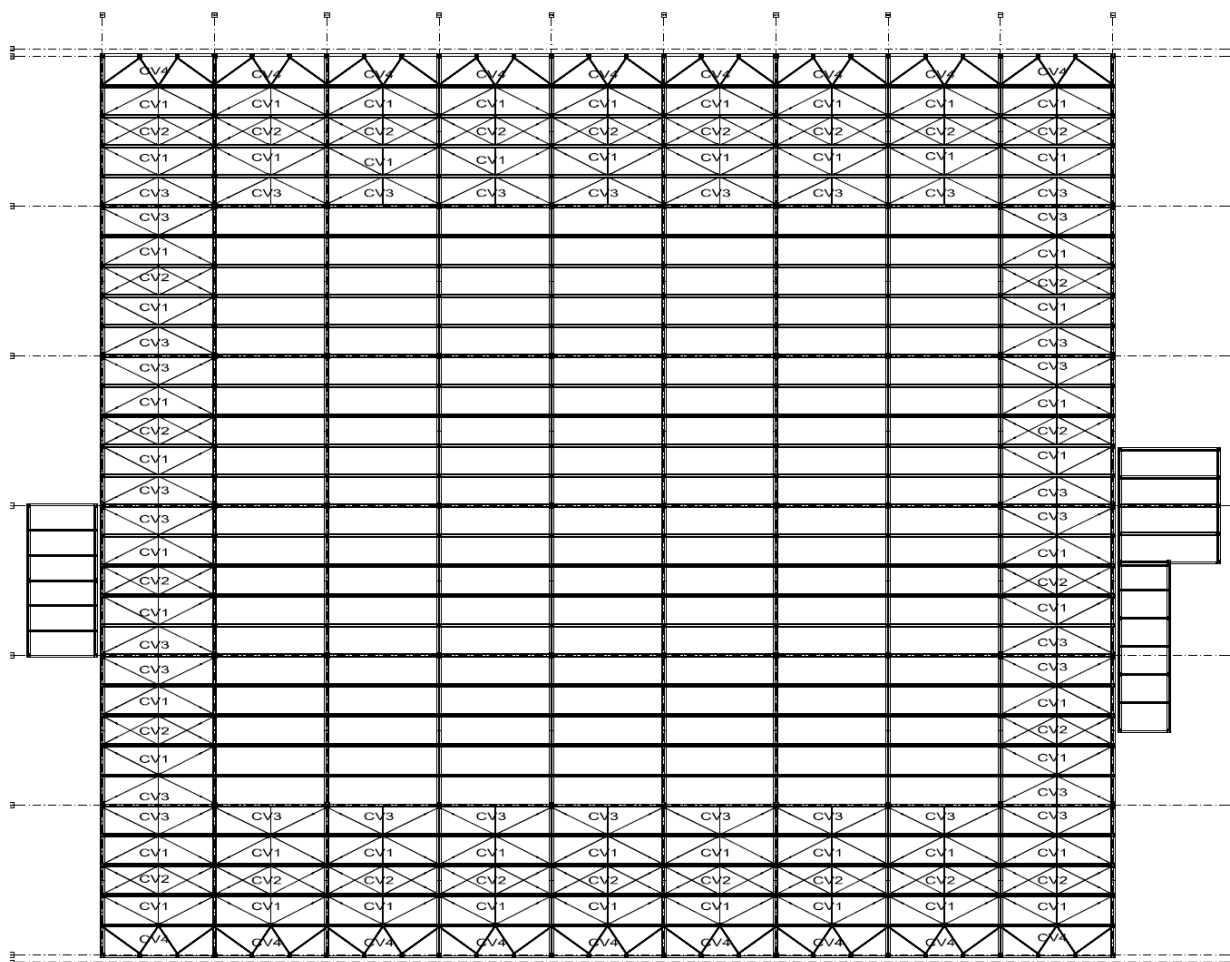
Plan montaj contravântuiri – planșeu terasă
